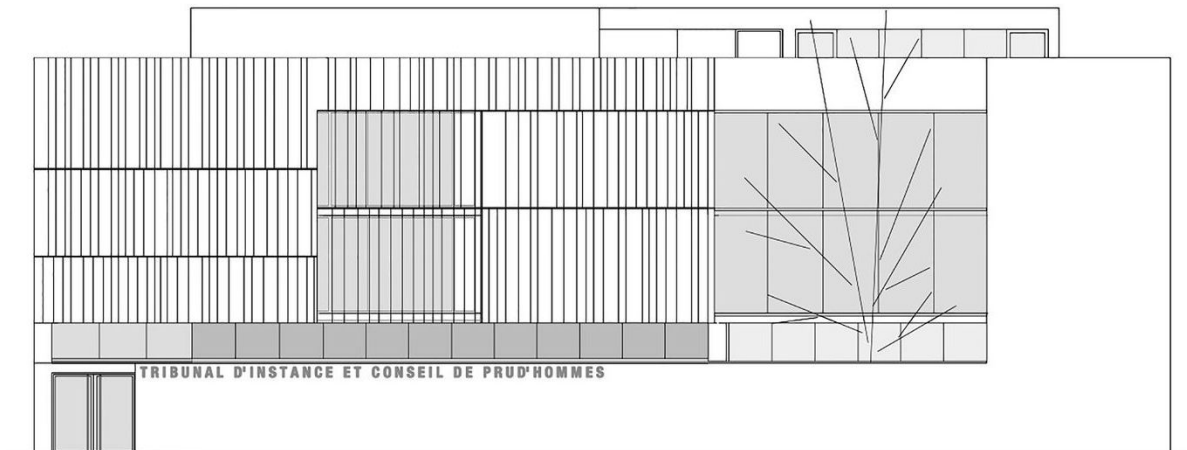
Alzado frontal. Fuente archdaily.mx. Sin escala.
